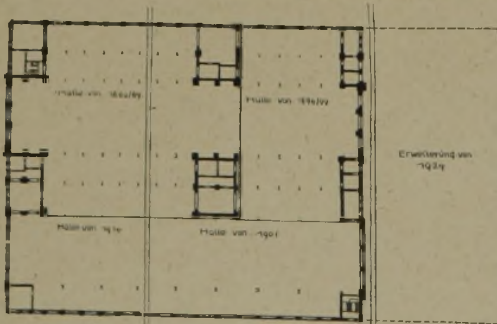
Grundriß der Maschinenbauhalle vor dem Umbau (1:2000). Abb. 6. Dsgl. nach dem Umbau 1924. Abb. 1-6. Um- und Erweiterungsbau der Großmaschinen-Bauhalle a.d. Werft Kiel.
